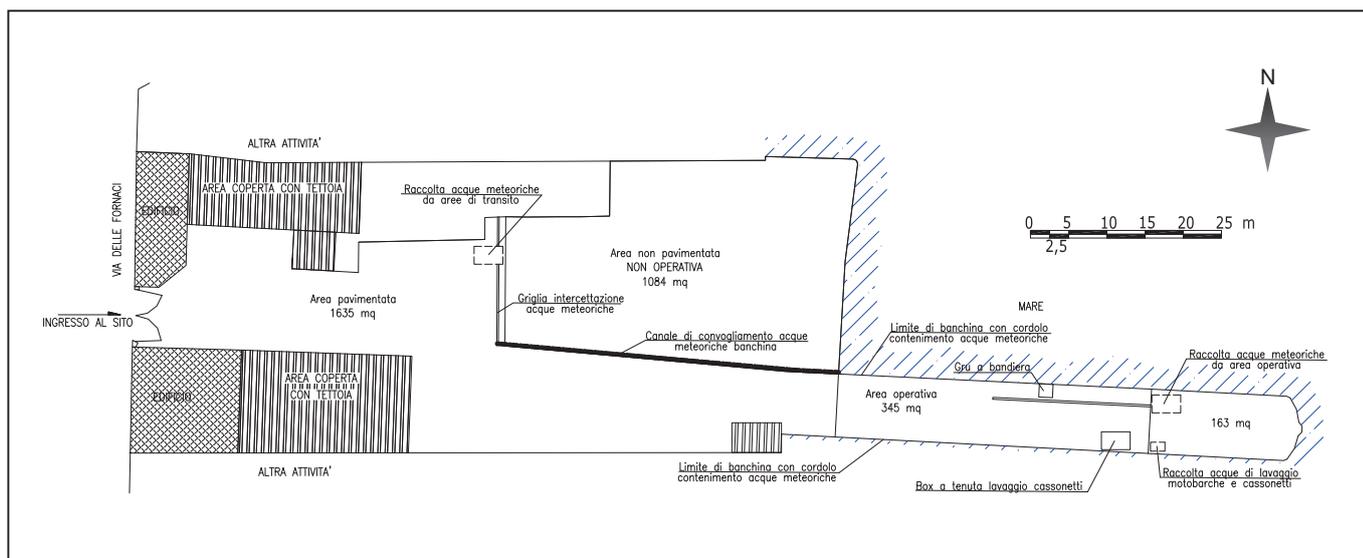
Planimetria di dettaglio sito Nigromare Srl porto mercantile
